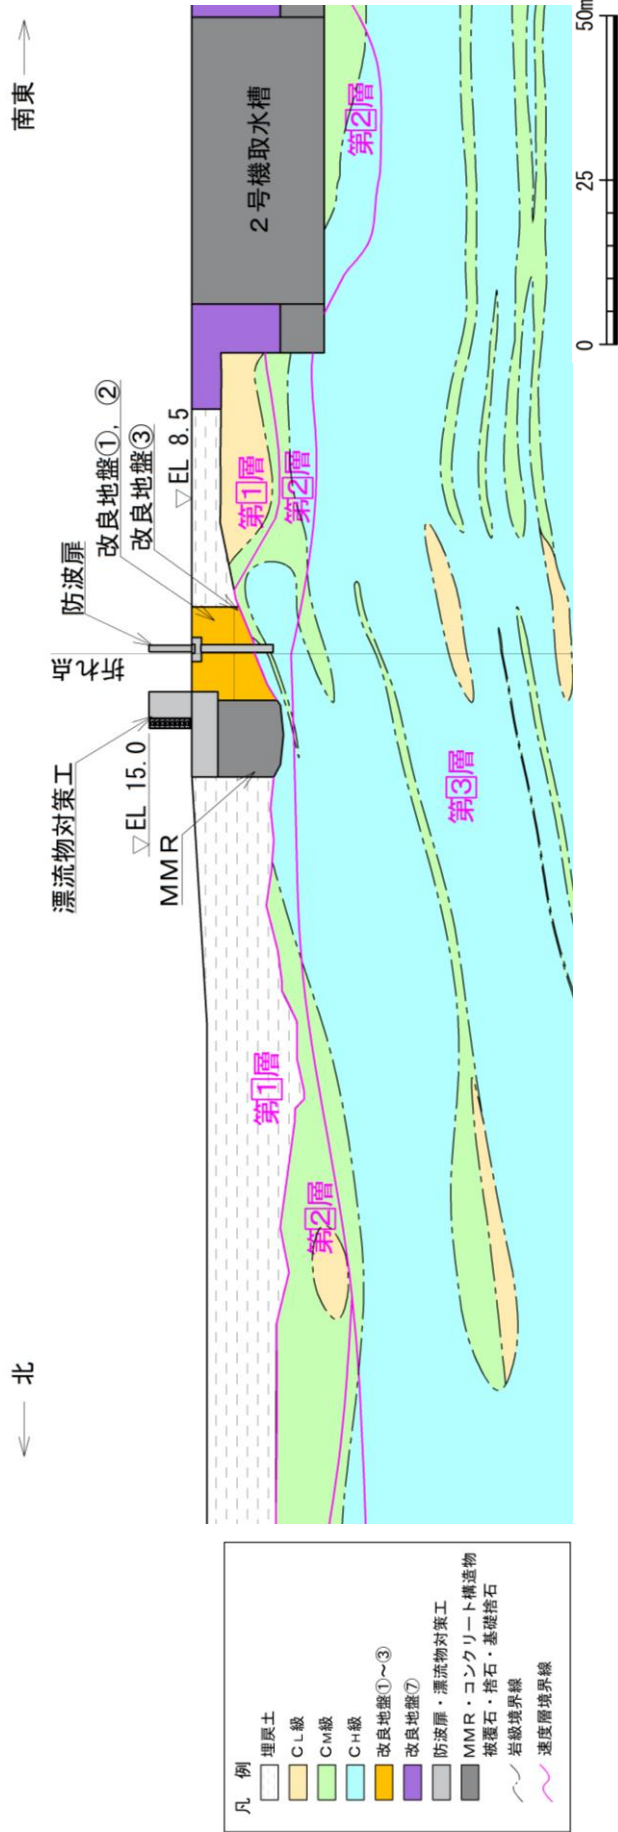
防波扉 (荷揚場南) の縦断面図
